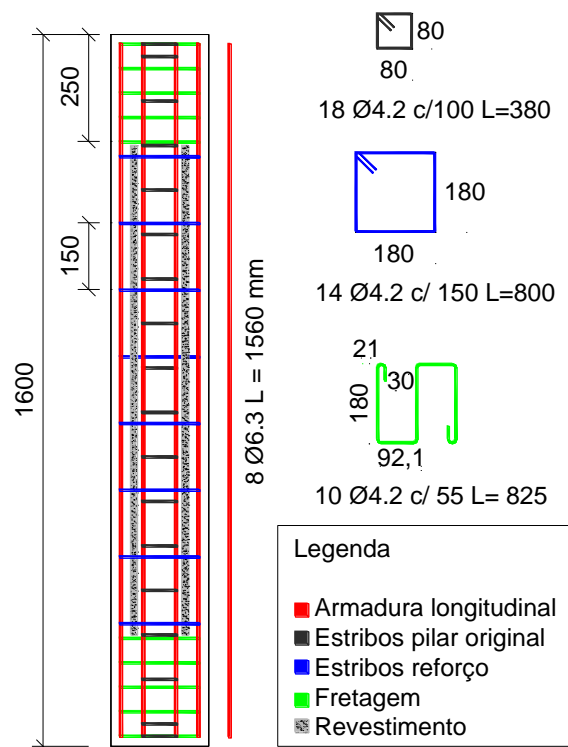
Detalhamento da armadura do pilar PR₁₅₀
